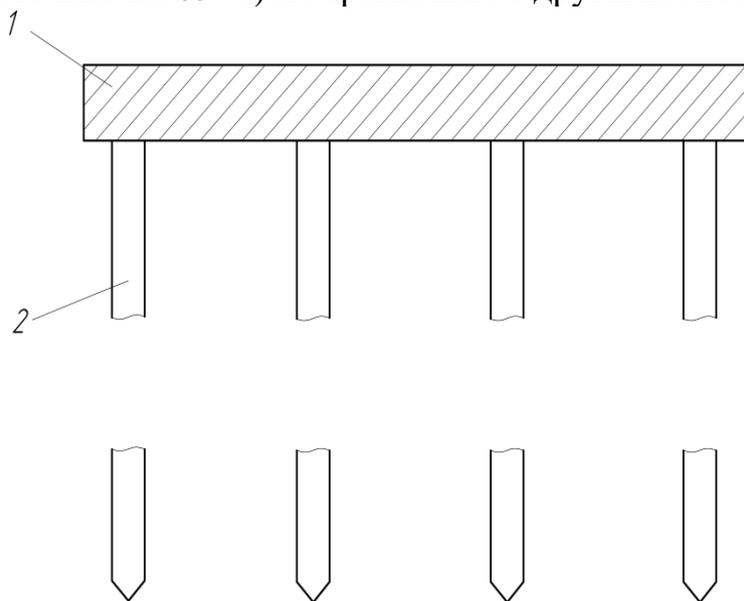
Свайный фундамент: 1 – ростверк; 2 – сваи
